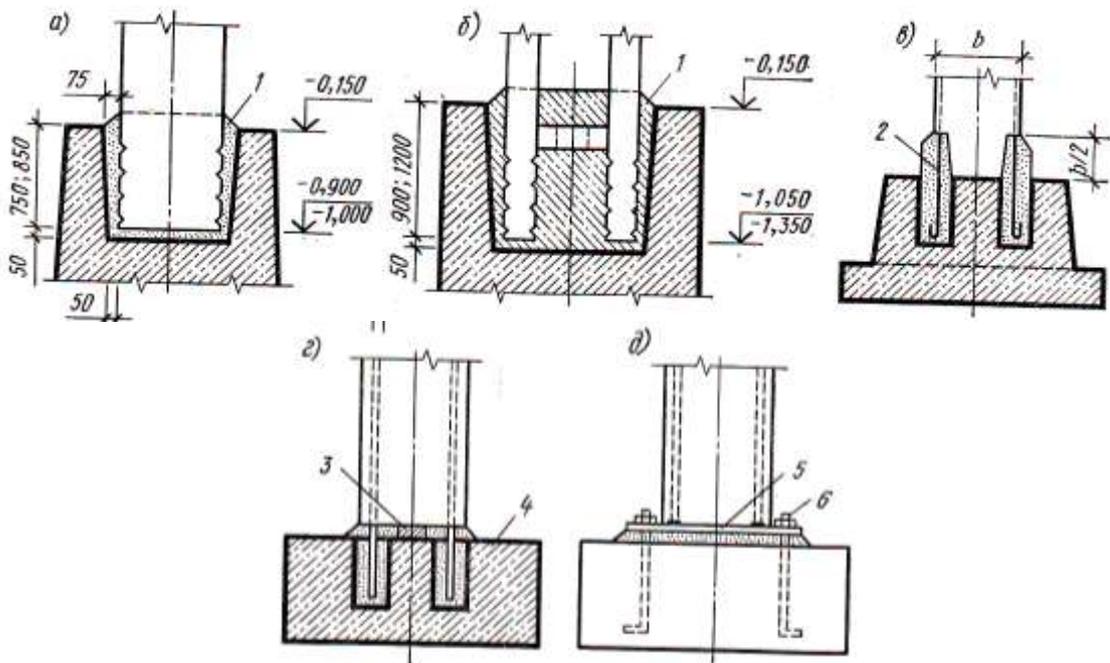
Стыки ж/б колонн с фундаментами:
